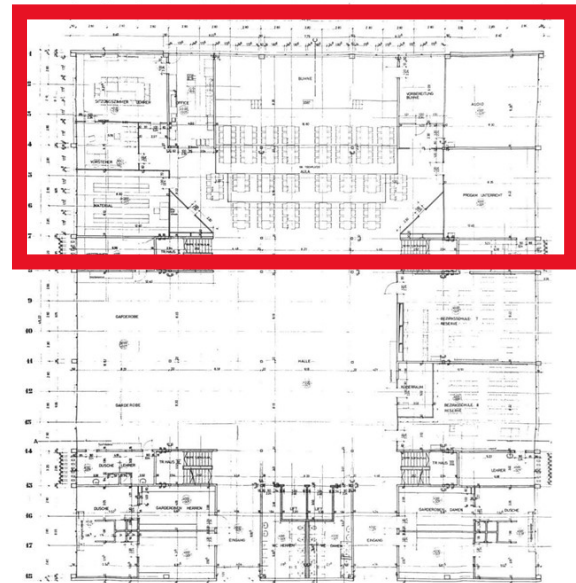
, Planausschnitt Erdgeschoss Schultrakt
